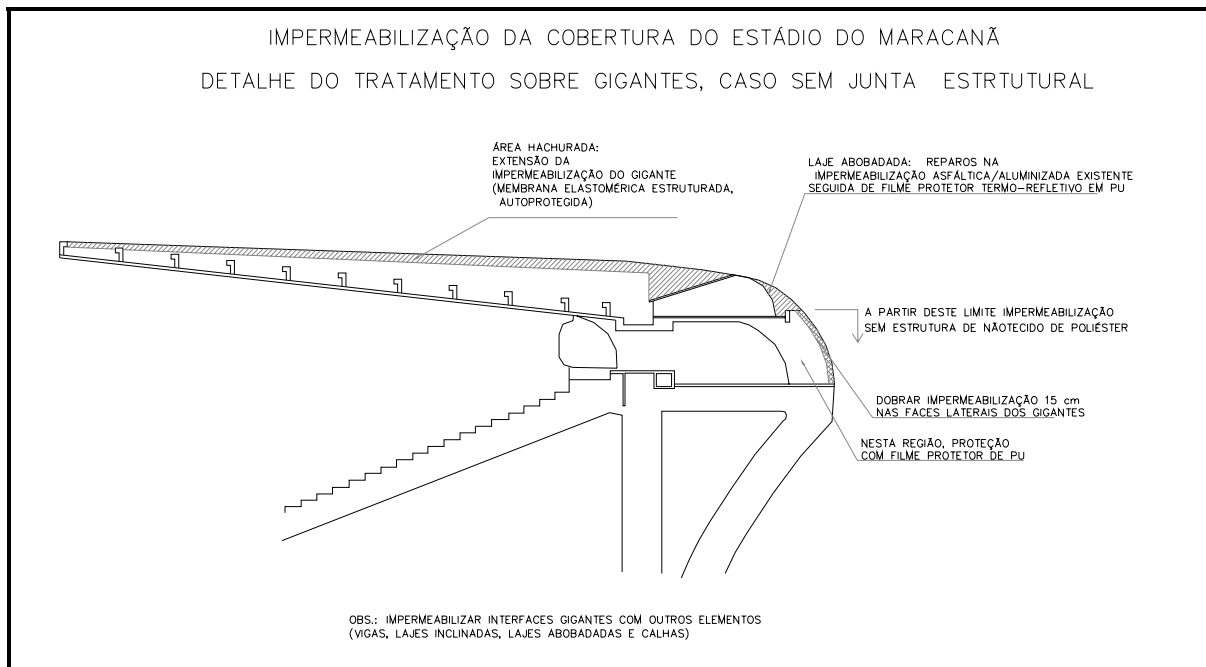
Detalhe da impermeabilização das estruturas de “balanços de gigantes”.
